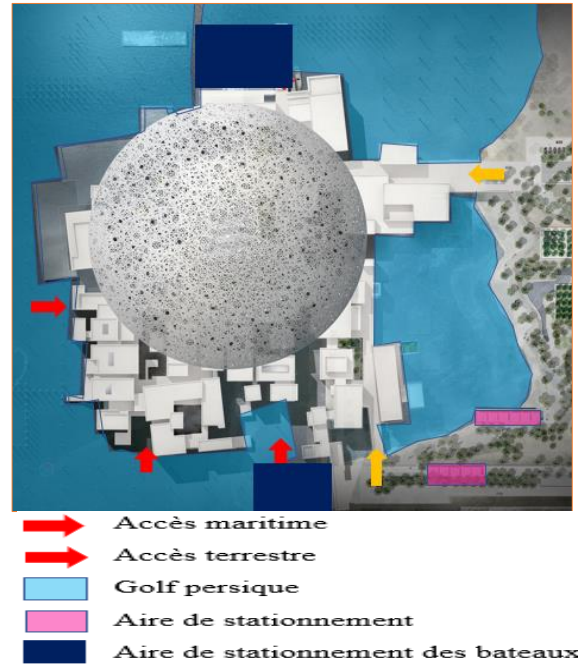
plan de masse de Louvre Abu Dhabi.
